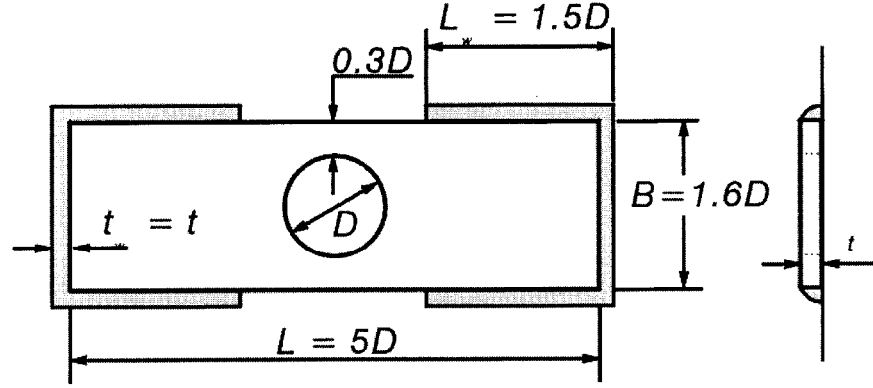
Figura J. Dimensiones relativas de la platina perforada de acero propuesta para las conexiones soldadas.
